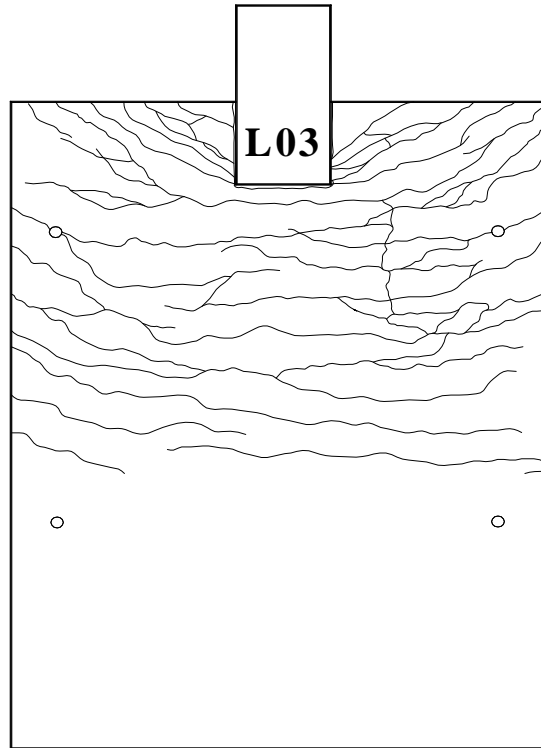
Padrão de fissuração da face inferior da laje – L3
